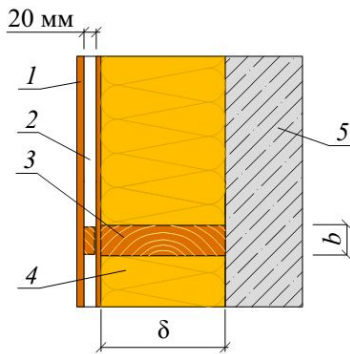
Ж/б стена с наружным утеплением: 1 – наружная облицовка; 2 – 20 мм вентилируемого слоя; 3 – рейка с шагом 0,6 м; 4 – тепловая изоляция; 5 – ж/б стена
